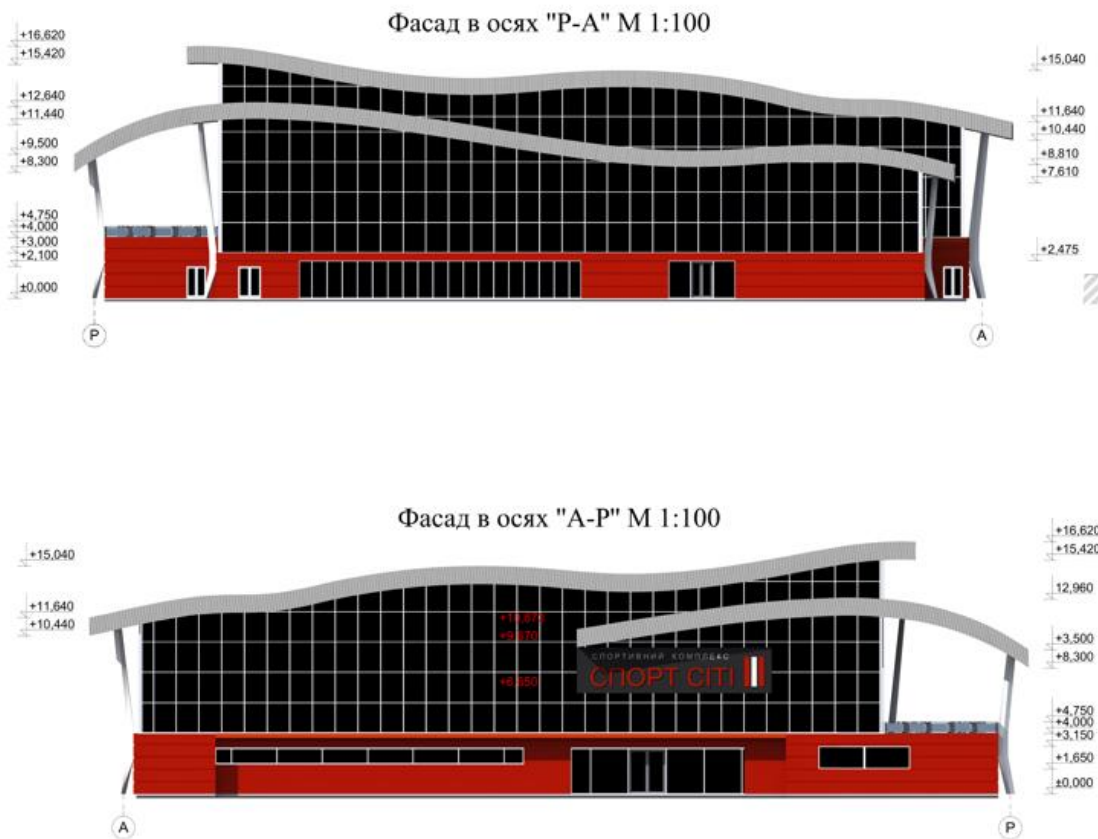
Фасад будівлі спортивного комплексу: а) фасад в осях Р-А; б) фасад в осях А-Р.
